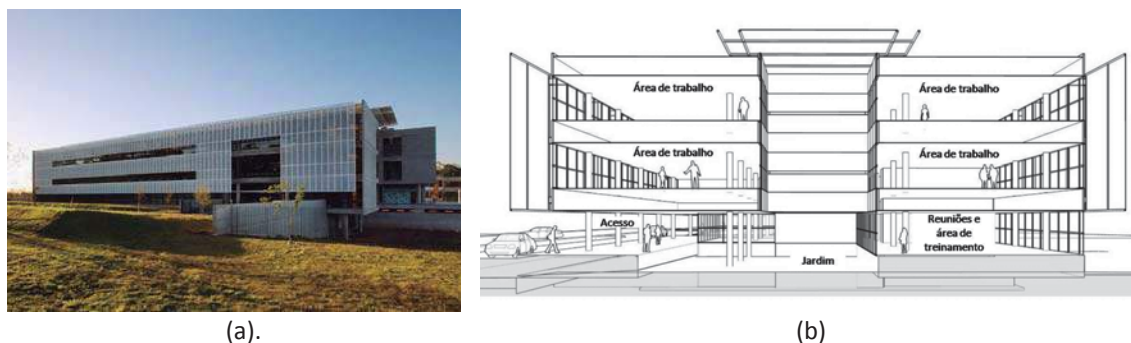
(a) Corte esquemático; (b) Corte esquemático.
